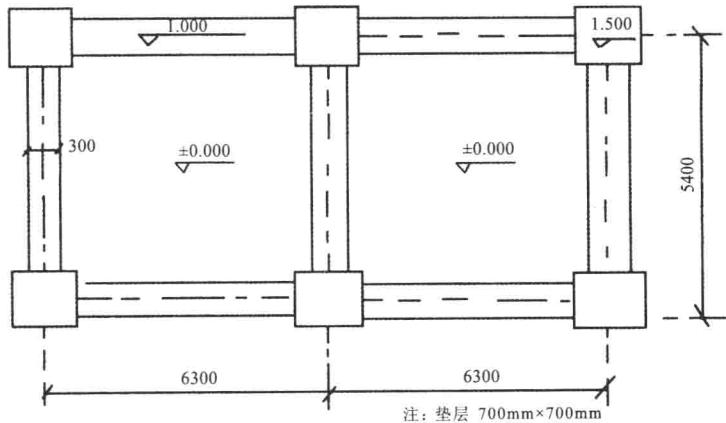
基坑开挖平面图(单位:mm,标高单位:m)
